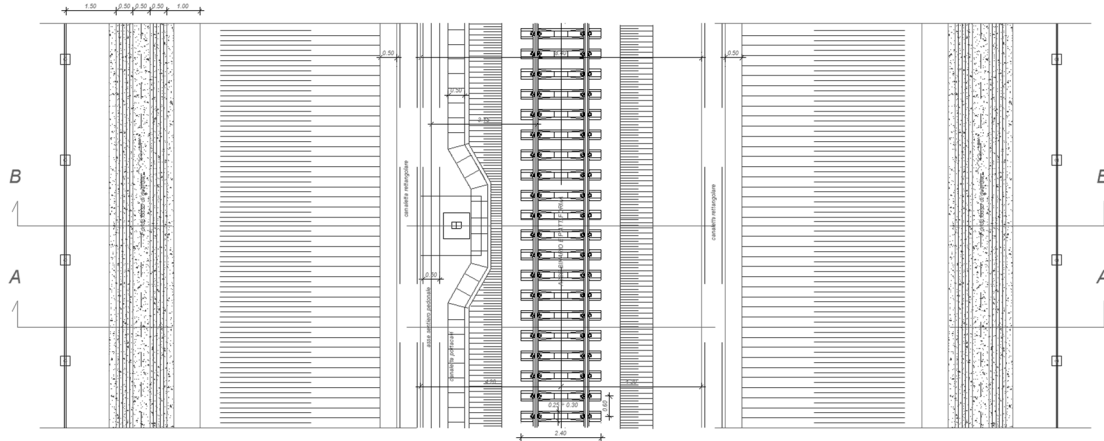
Stralcio planimetrico con sezione tipo ferroviaria in trincea a singolo binario in rettilo
